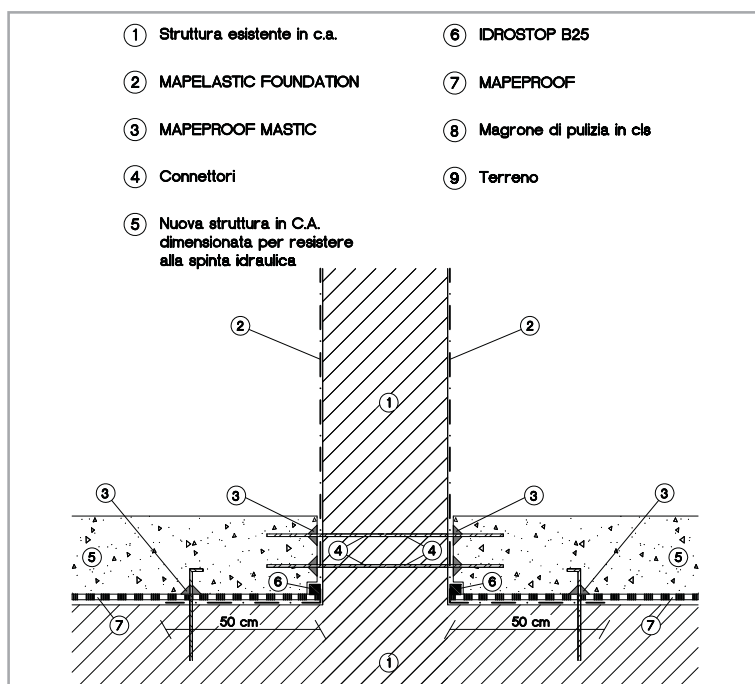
Particolare tecnico di una rifoderata interna eseguita applicando MAPEPROOF sulla superficie orizzontale e MAPELASTIC FOUNDATION sulle verticali: raccordo tra soletta e pilastro o setto.
